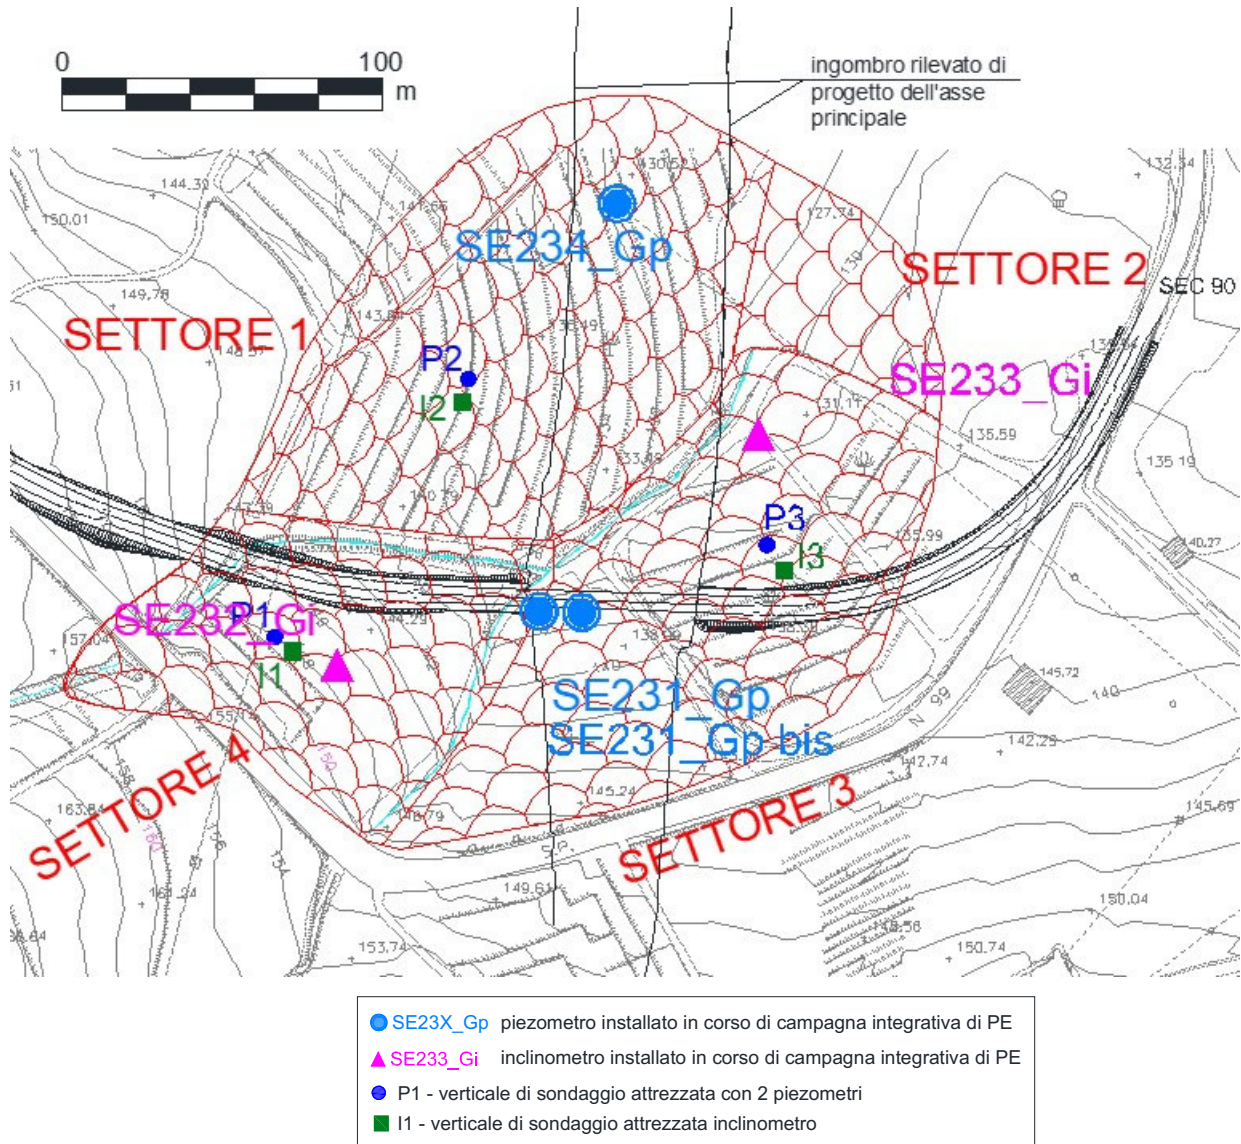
Planimetria con ubicazione della strumentazione di monitoraggio.
